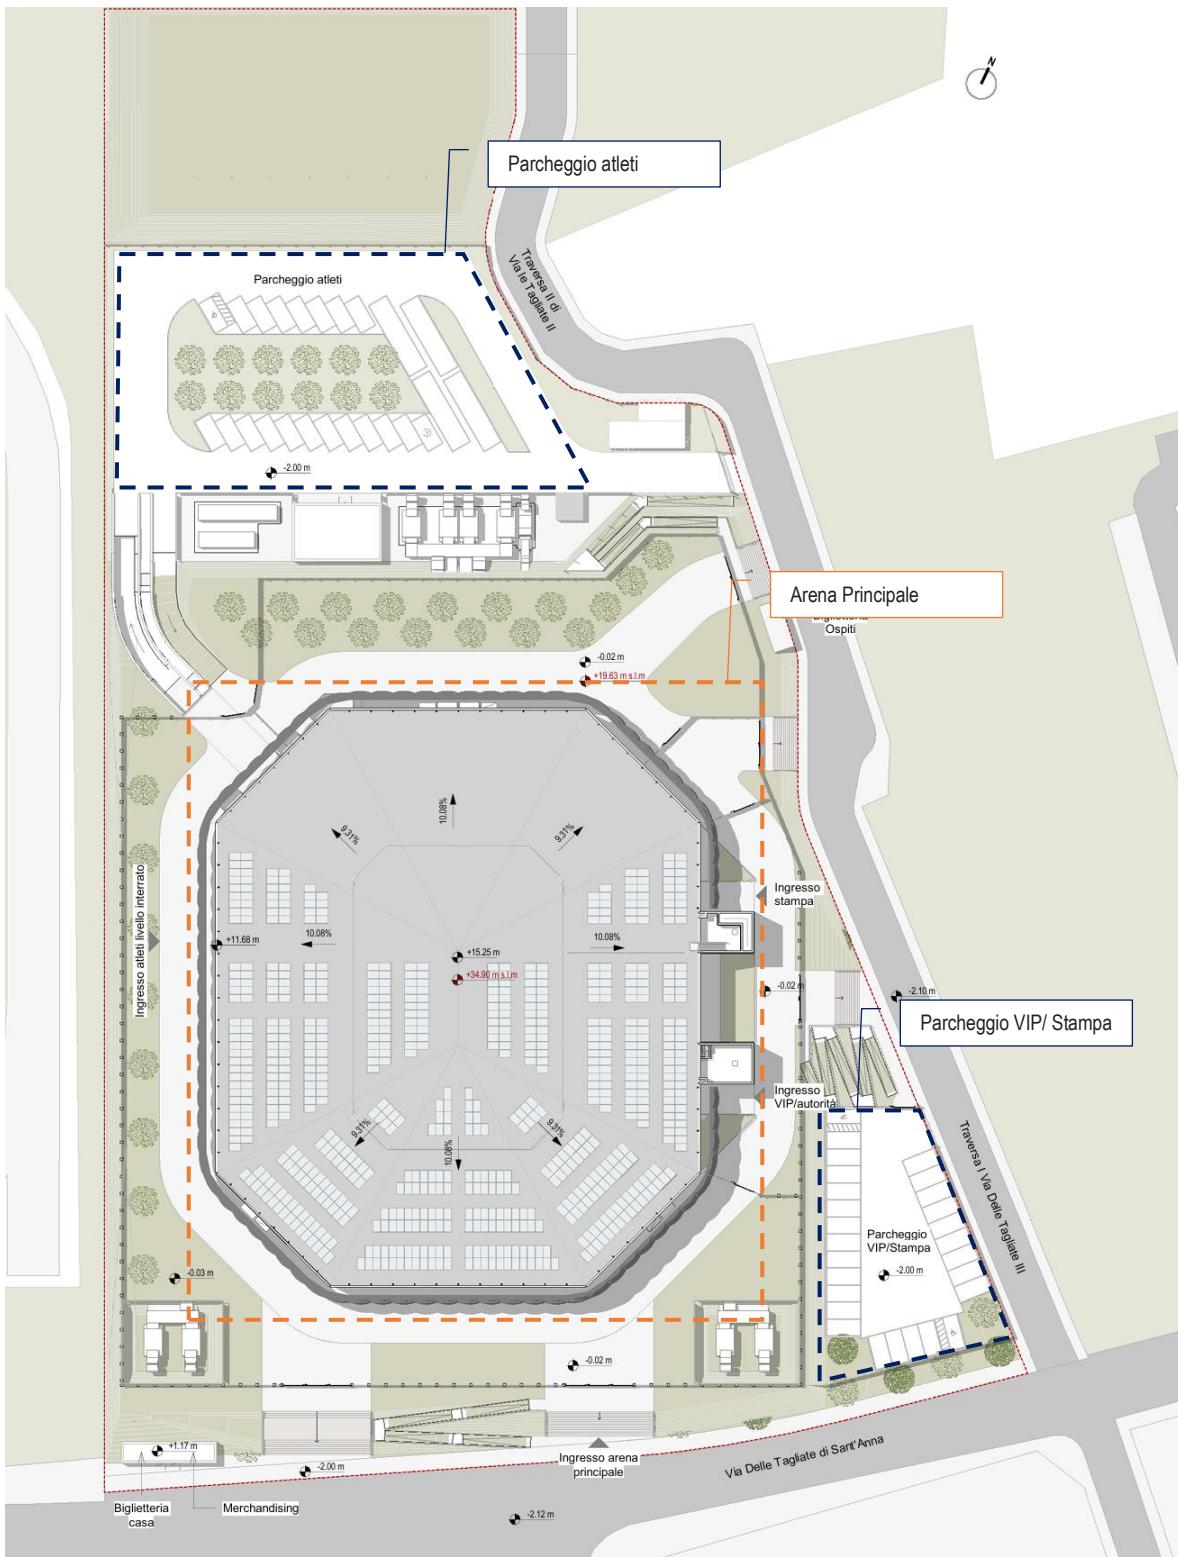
Planimetria generale dello Stato di progetto (fonte: ATI Project).
